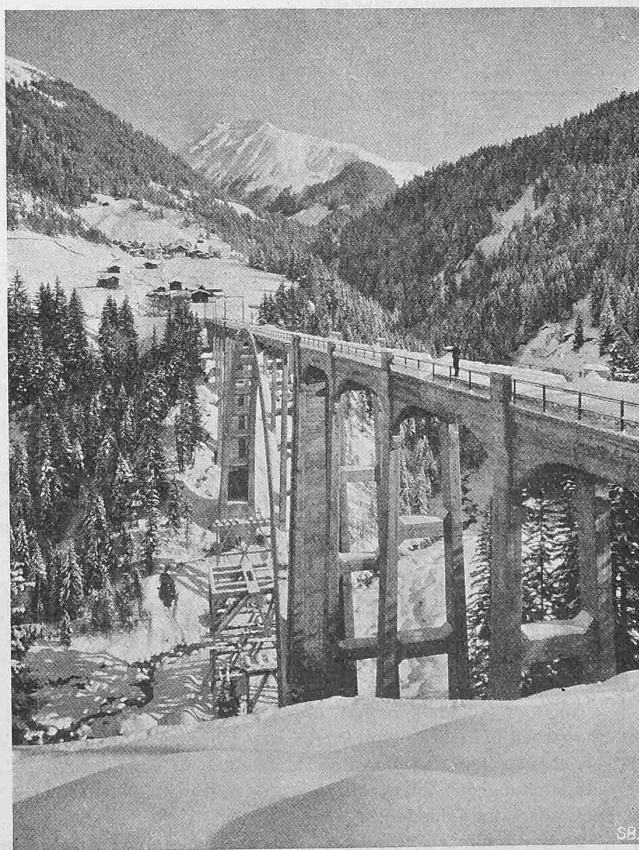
Langwieser-Viadukt, gegen Osten gesehen. (Unter dem Bogen der Eisenbeton-Unterbau des Baugerüsts.)
